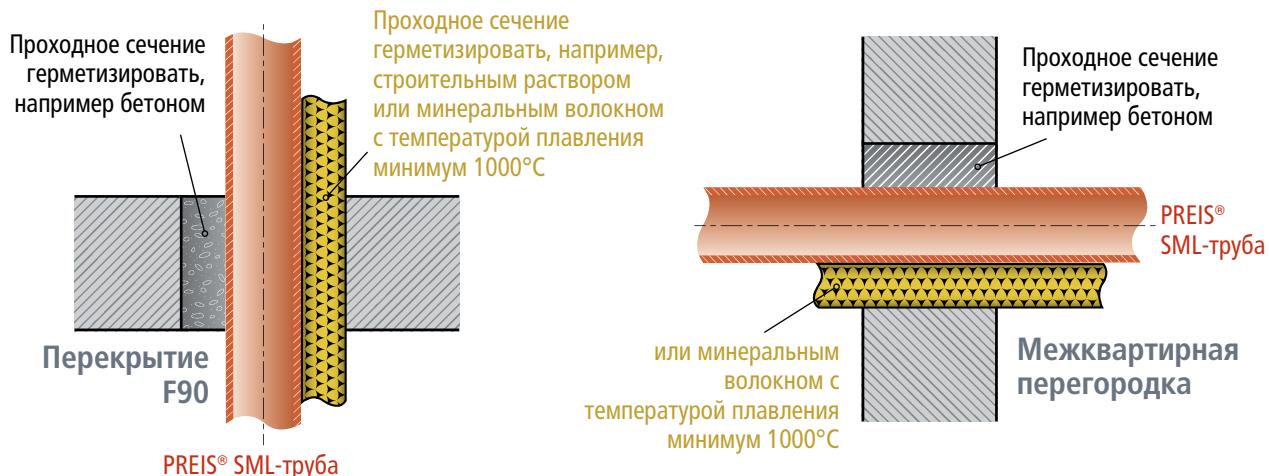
Требования относительно противопожарных мероприятий к проведению трубопроводов через перекрытия
